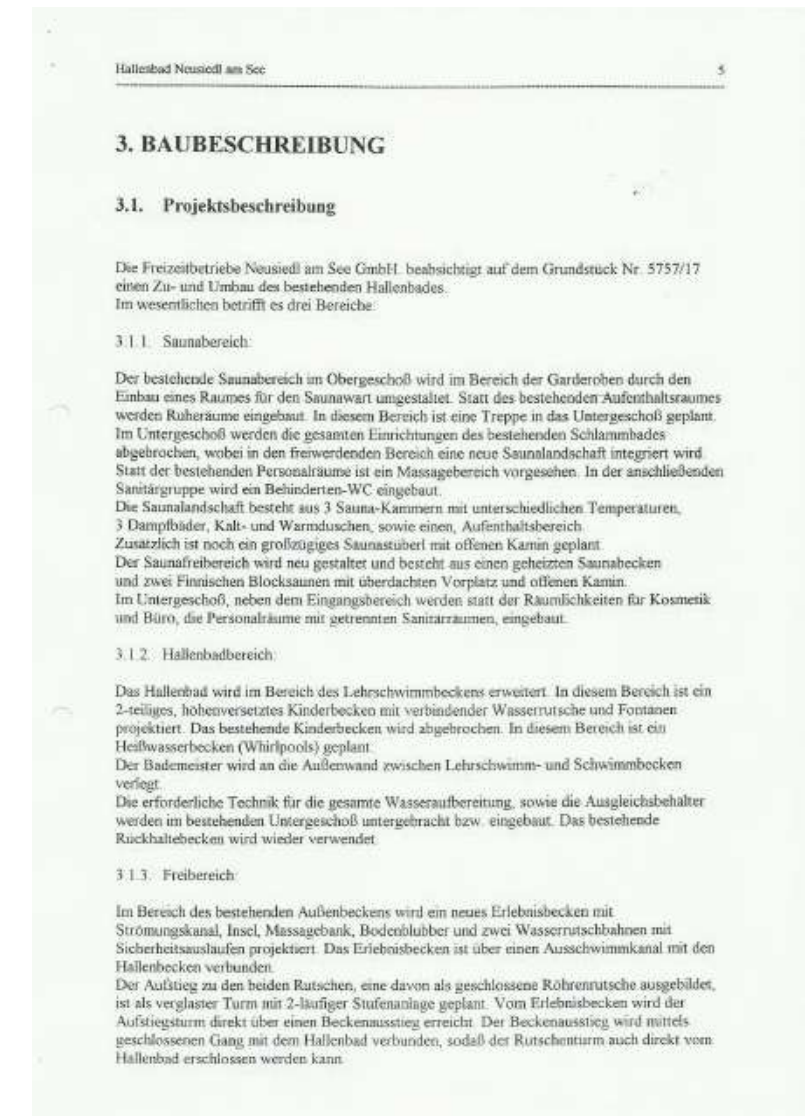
2: originale Baubeschreibung 1996, Archiv Hallebad
